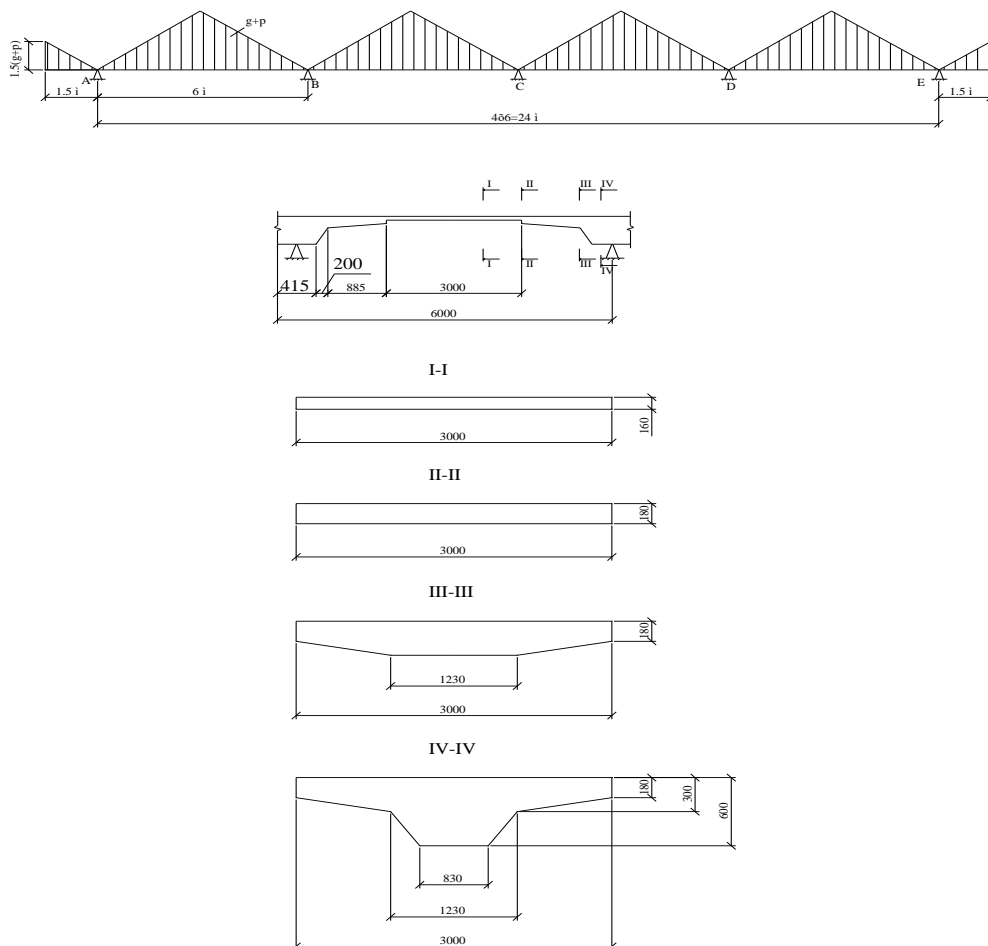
Розрахункова схема поперечної рами безбалочного перекриття і розміри поперечних перерізів.
